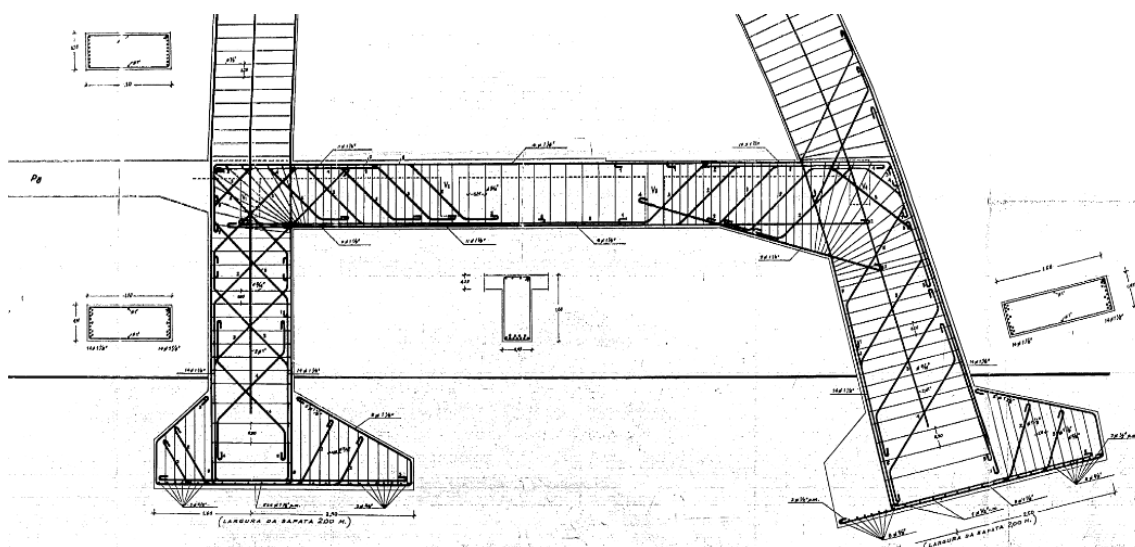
Vista geral das sapatas do pórtico do pavilhão (projeto de estruturas)
